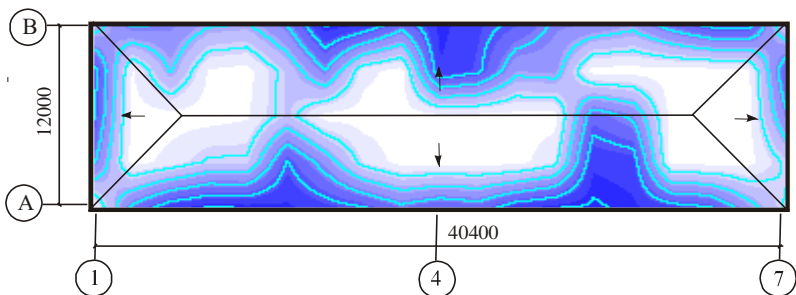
Пример наложения дефектограммы водоизоляционного ковра на план кровли жилого здания
